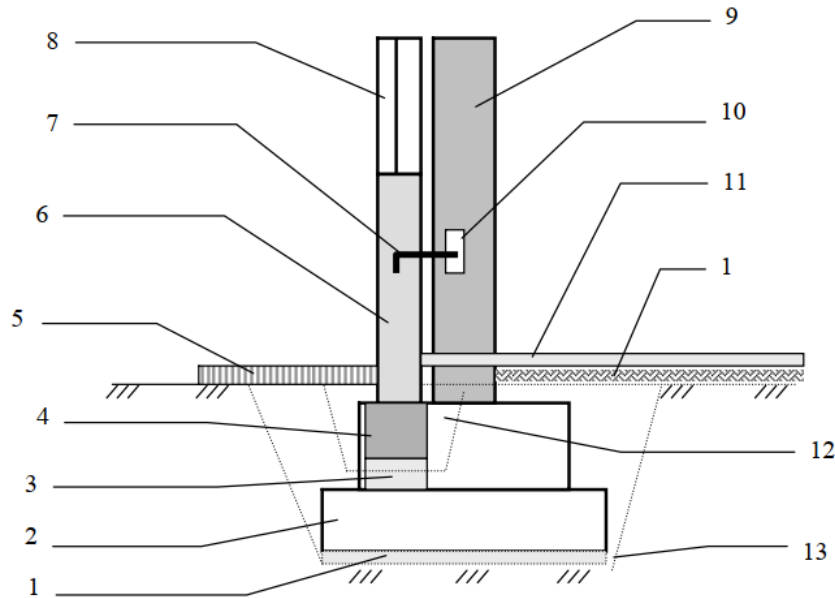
Приклад встановлення стіни на фундаментну балку:
